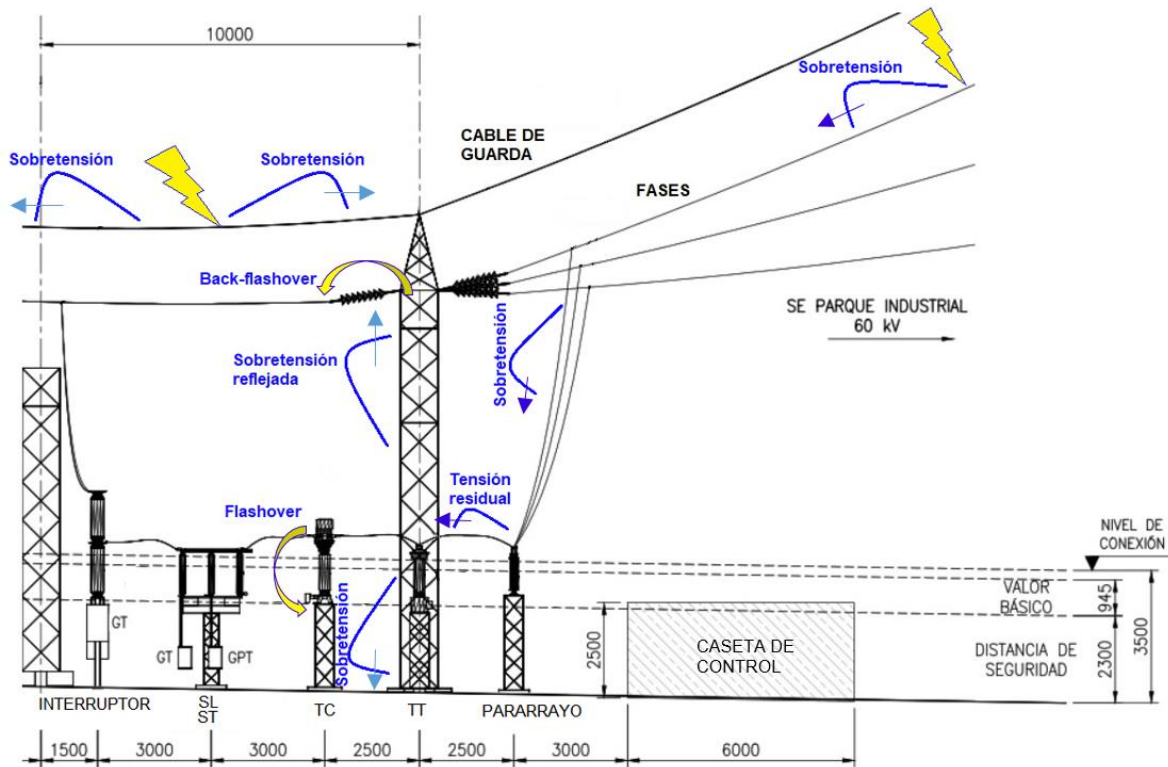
Flashovers y back-flashovers en instalaciones de una S.E
